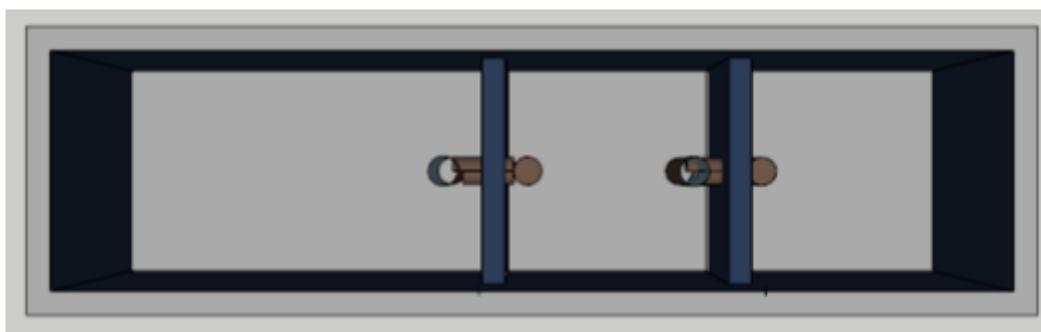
Trampa de grasa Italcol planta 1 vista 3D, planta
